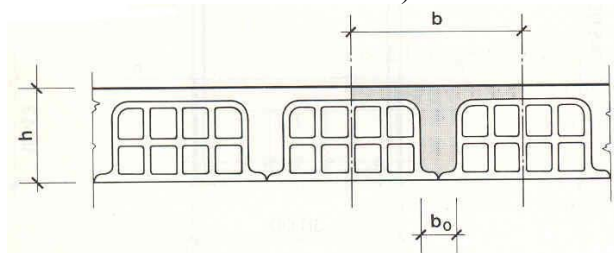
Sezione trasversale di un solaio latero-cementizio
